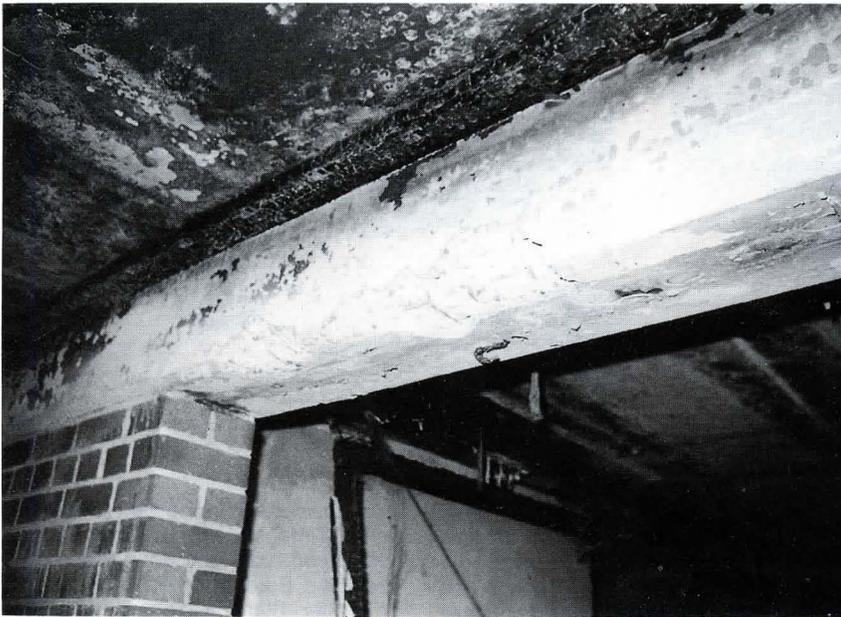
Stahlbetonsturz und Stahlbetondecke, beide thermisch beschädigt
